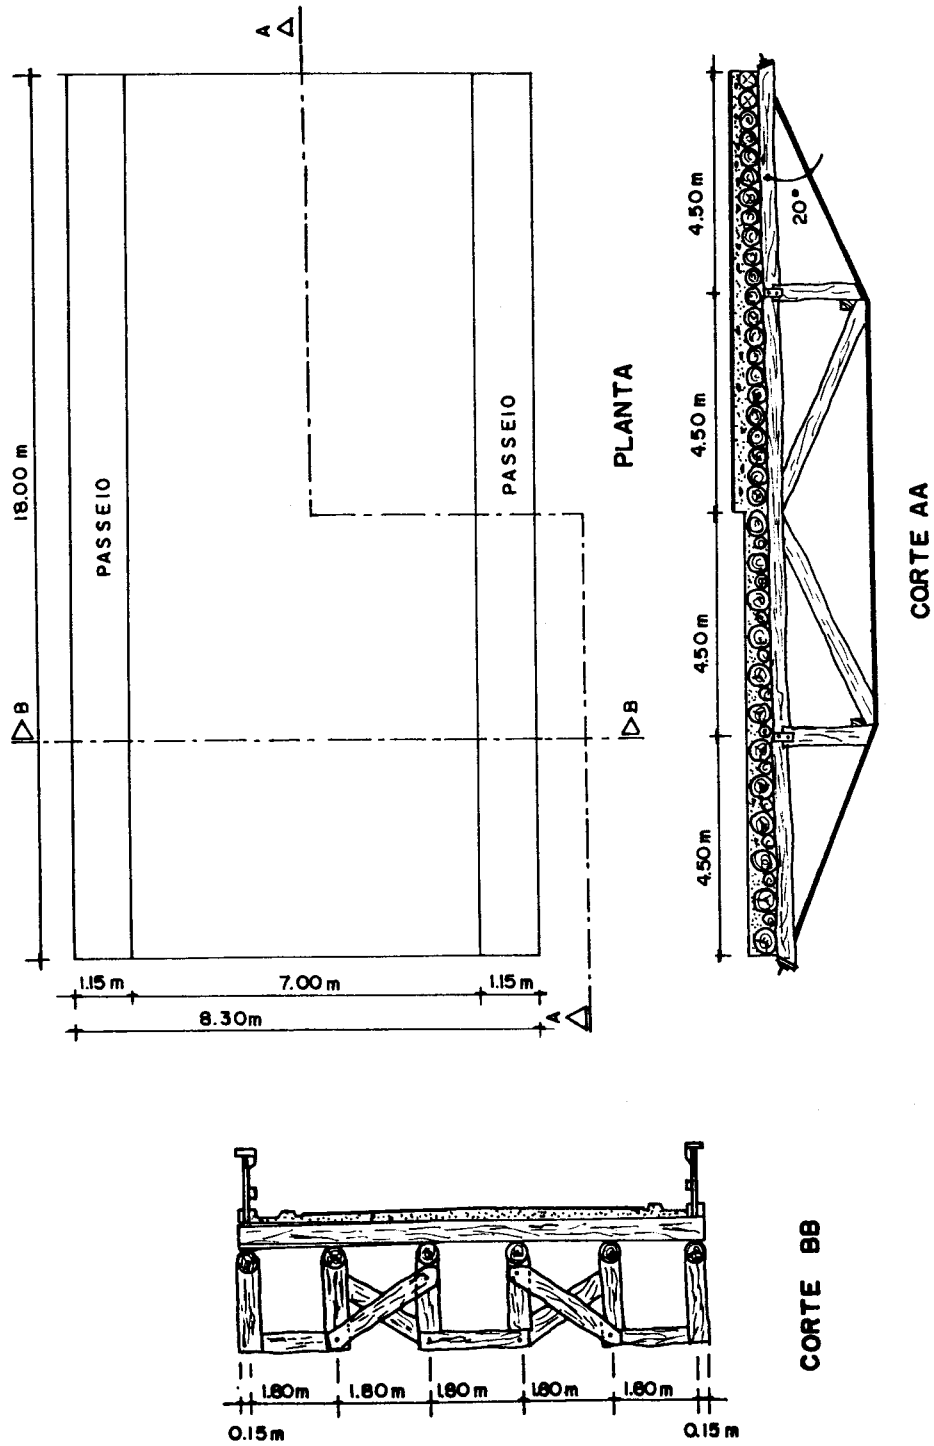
Modelo de ponte com viga armada instrumentado por LOGRADO.
